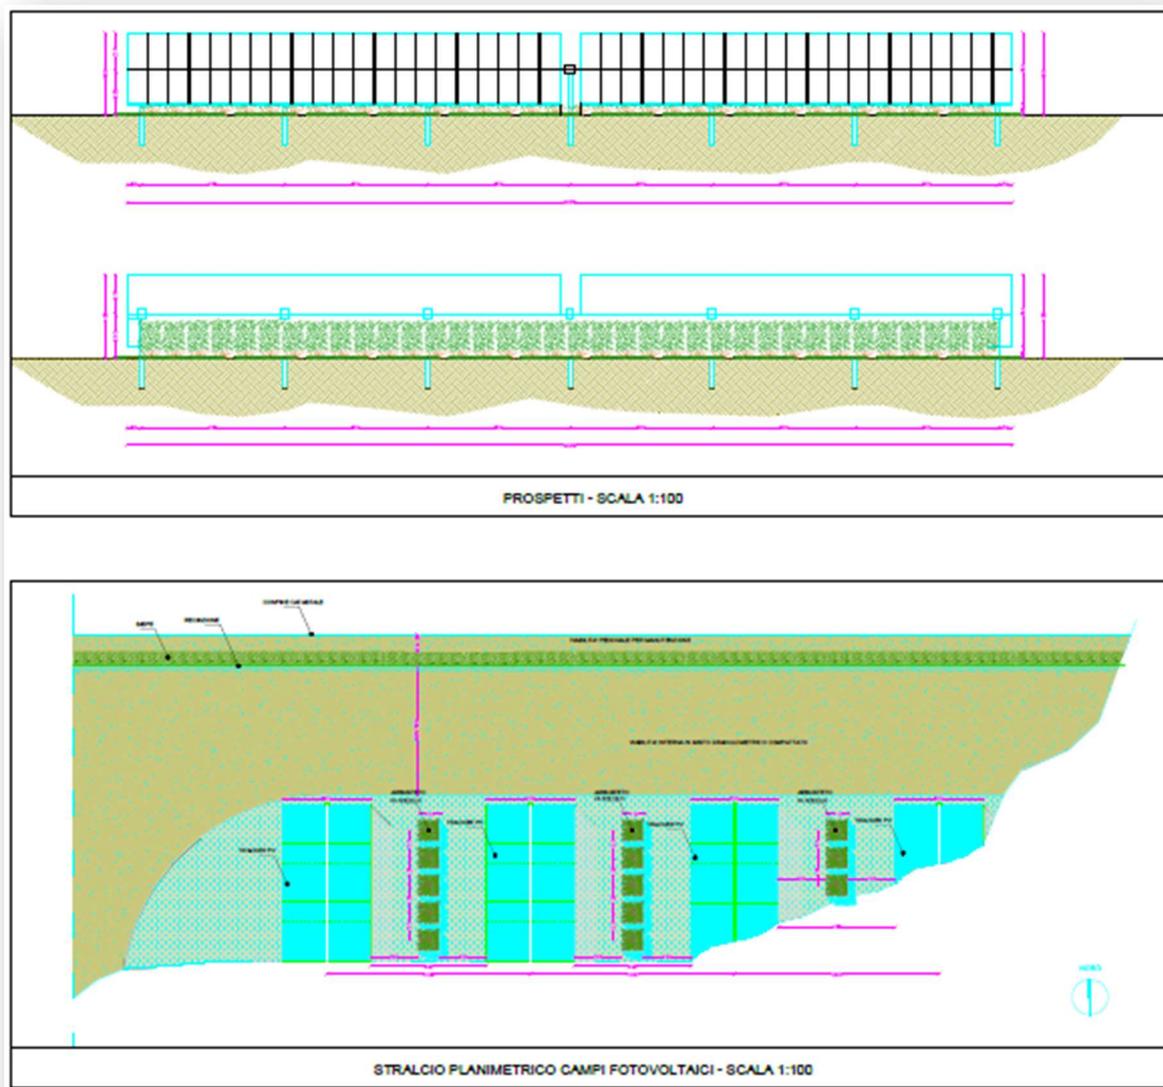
Estratto Elab. R.5.a Stralcio planimetrico e prospetti
